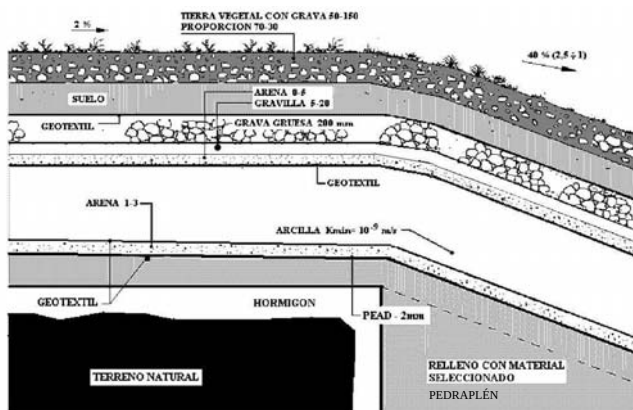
Vista en sección de las capas que constituyen la cobertura de ensayo II.
